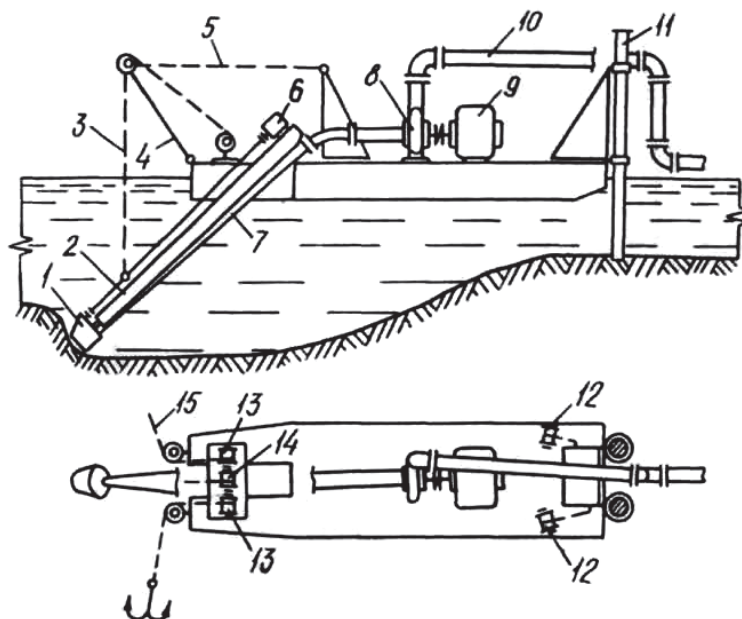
Схема земснаряда: 1 – рыхлитель; 2 – рама рыхлителя; 3 – подвеска рамы рыхлителя; 4 – укосина; 5 – подвеска укосины; 6 – двигатель рыхлителя; 7 – всасывающий патрубок; 8 – грунтовый насос; 9 – двигатель грунтового насоса; 10 – напорный пульпопровод; 11 – свайный аппарат; 12 – сваеподъемная лебедка; 13 – лебедка подъема рамы рыхлителя; 15 – якорный канат
